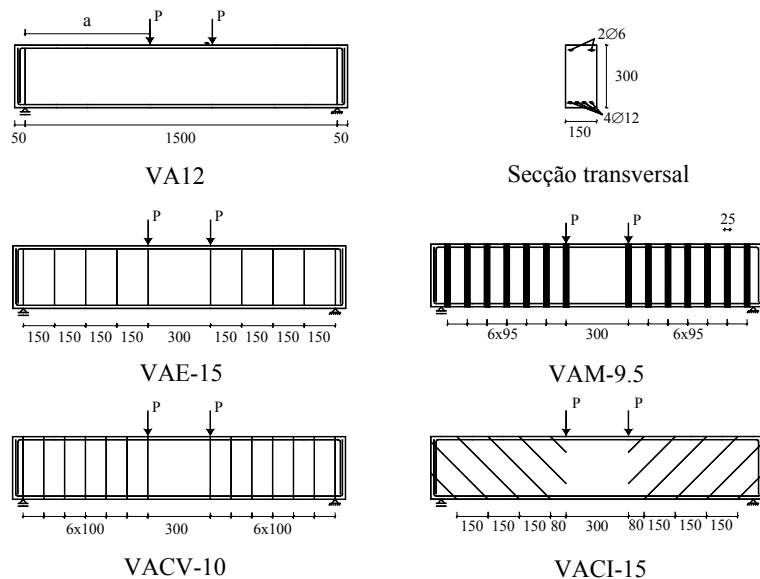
Vigas ensaiadas com 4 ϕ 12 longitudinais (dimensões em mm).
